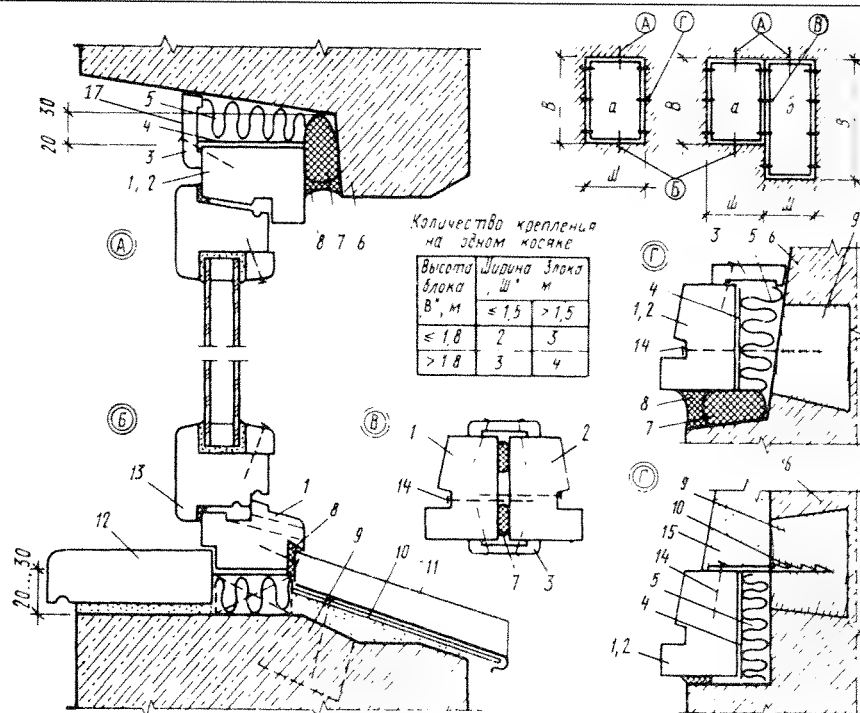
Крепление деревянных оконных блоков и блоков балконных дверей к стенам и герметизация стыков:
